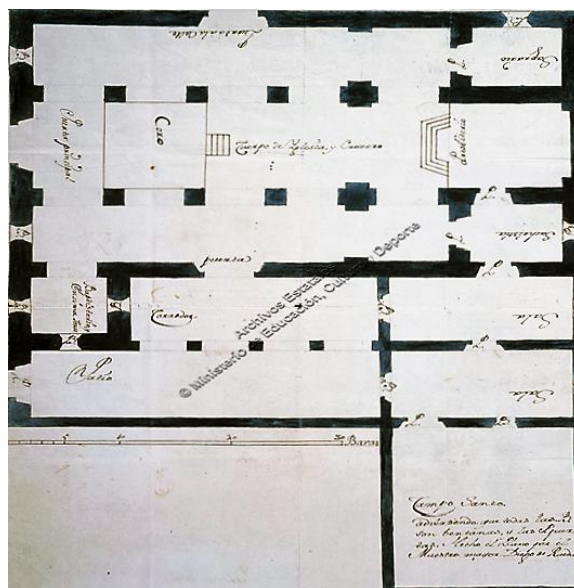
Plano de la catedral vieja de Santa Marta, 1647.
